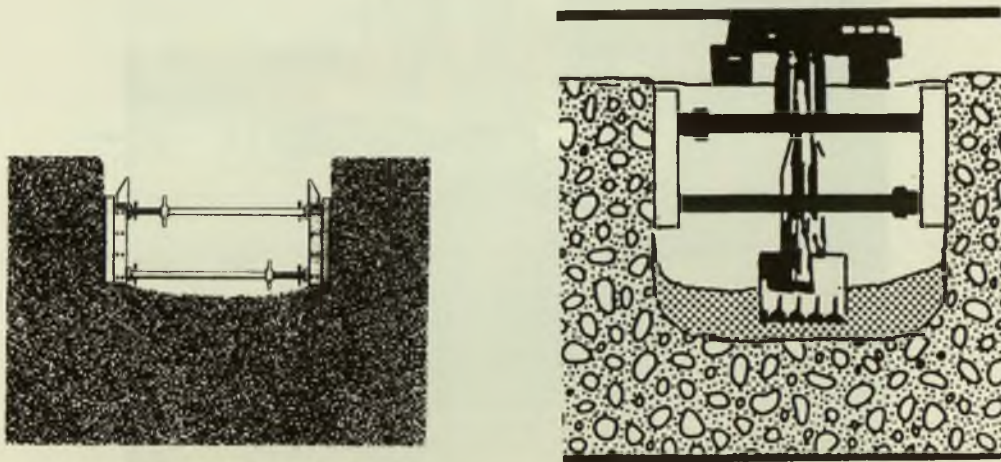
Colocación del módulo de blindaje en la excavación previa
